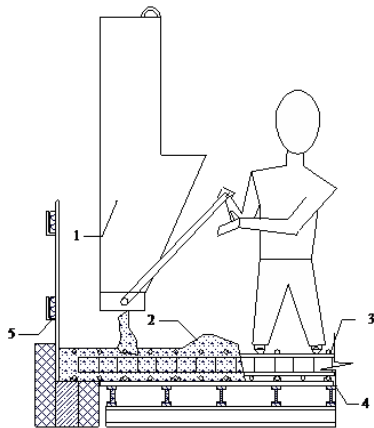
Укладання бетону: 1 - бункер для подачі бетону; 2 – бетон, що укладається; 3 - арматурна сітка; 4 - конструкція опалубки перекриття; 5 - інвентарна огороження
